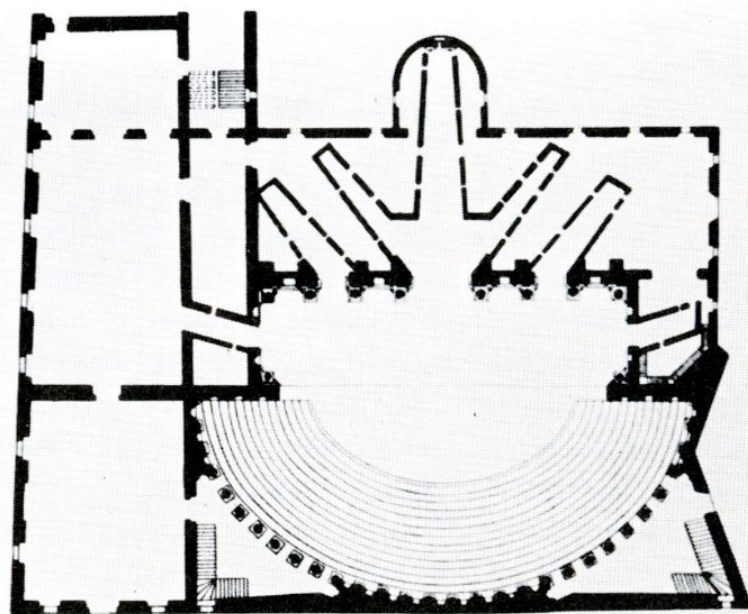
Planta do teatro olímpico, após intervenção de Scamozzi
